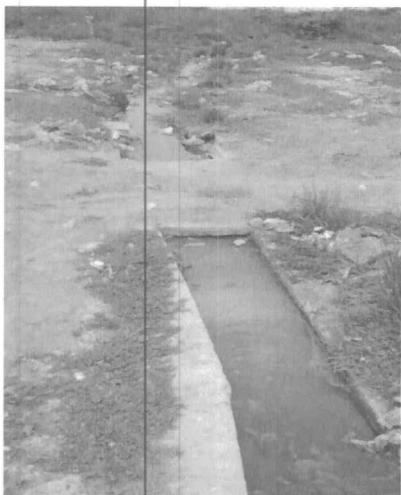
y 4. Se observa el rebosamiento del manhole ubicado en el barrio Villa Nerys
